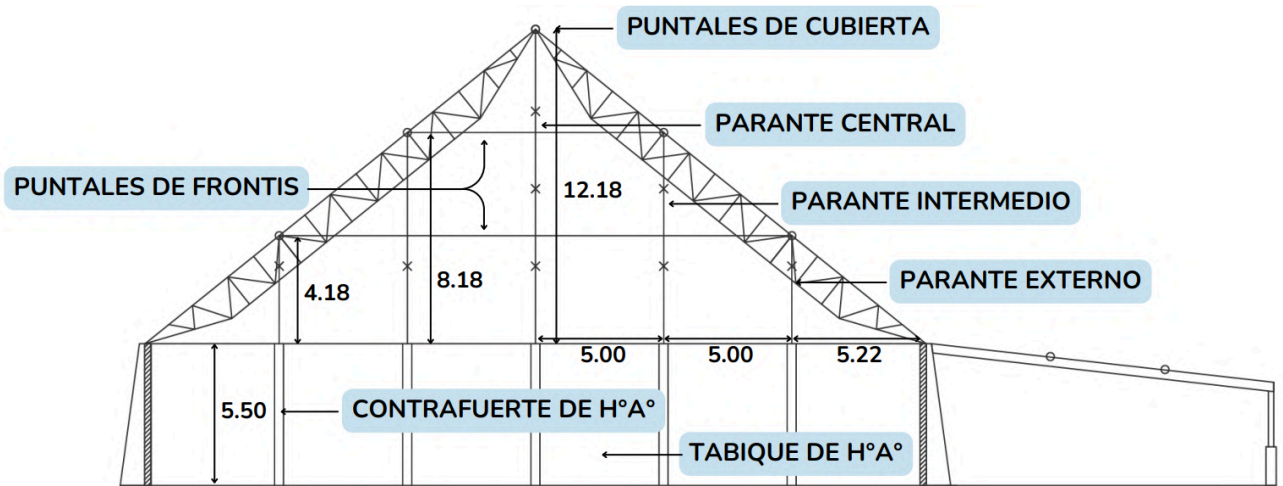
Estructura de frontis. Fuente: elaboración propia. Medidas en metros.
